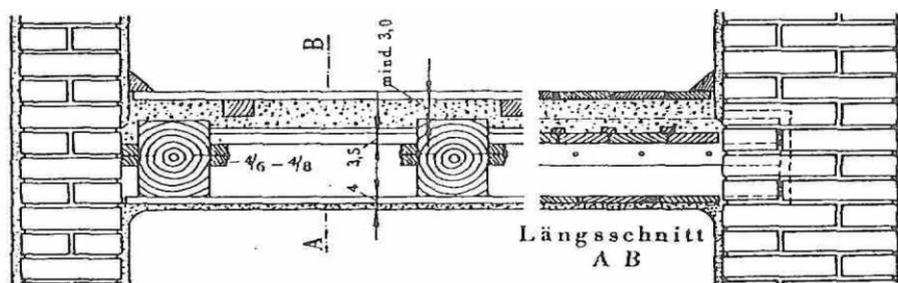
Tramdecke mit abgesenkter Sturzschalung
